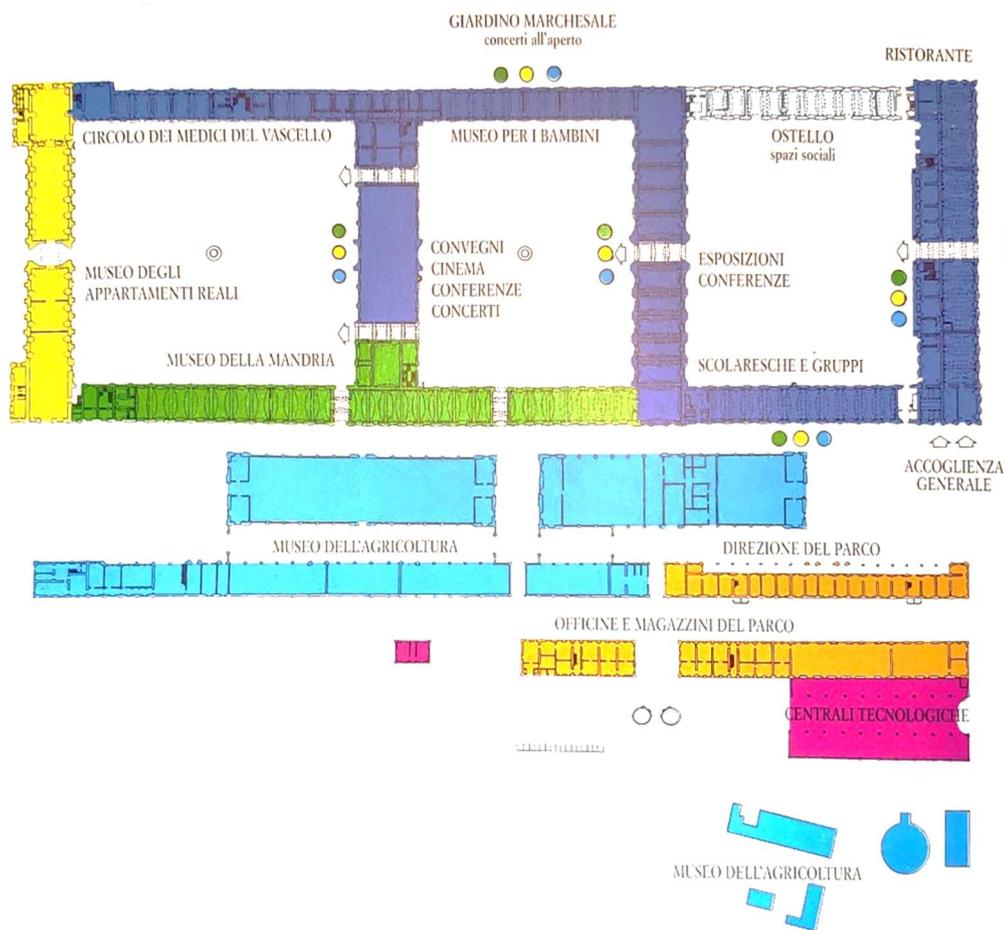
Complesso di Borgo Castello. Pianta piano terreno. Estratto
